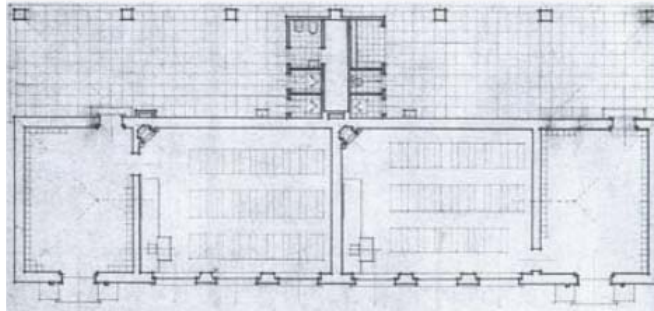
Escola tipo (um piso), Plano dos Centenários, planta
